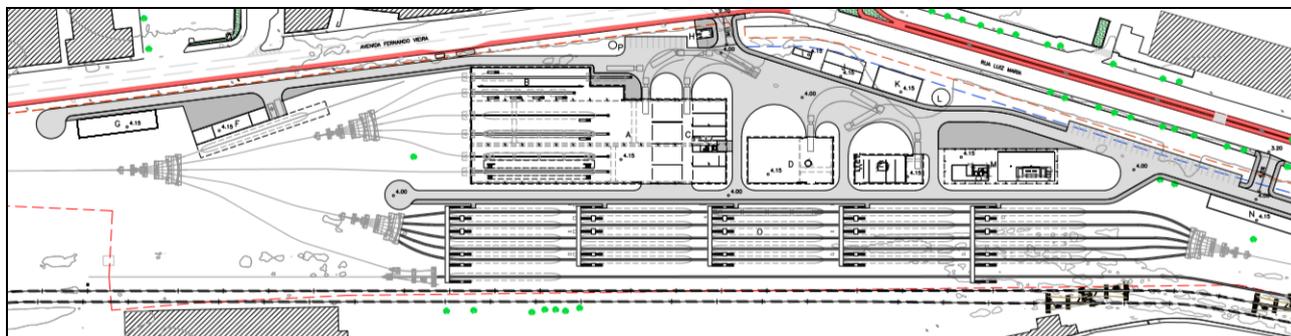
Planta Baixa do Pátio de Manutenção (Disponível para melhor visualização no ANEXO 2-2)
